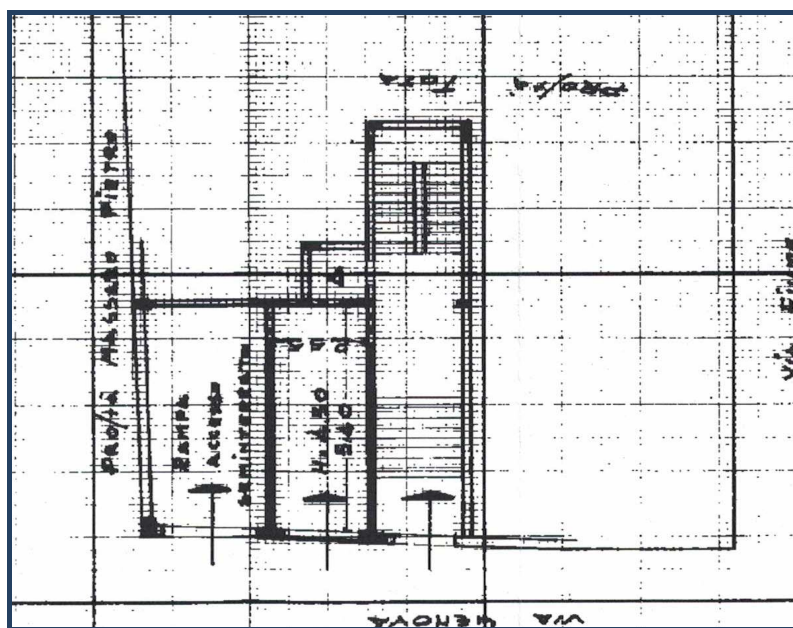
Rappresentazione planimetrica del locale al piano terra
